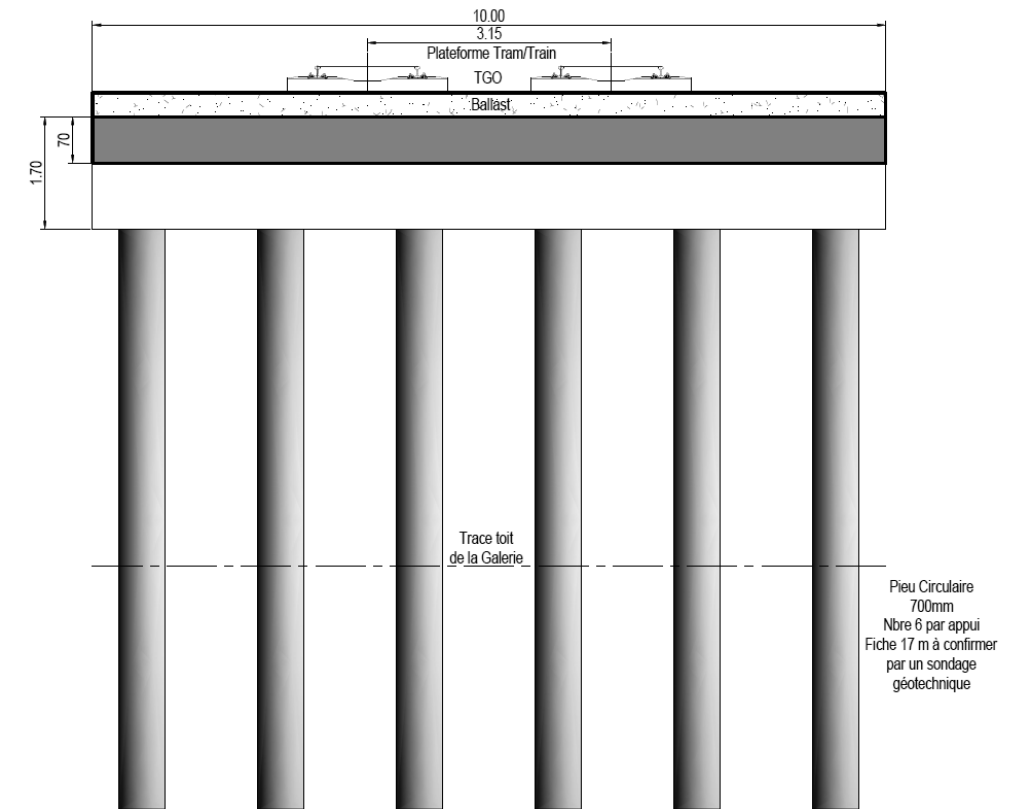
Ouvrage de franchissement de la galerie (coupe B)
